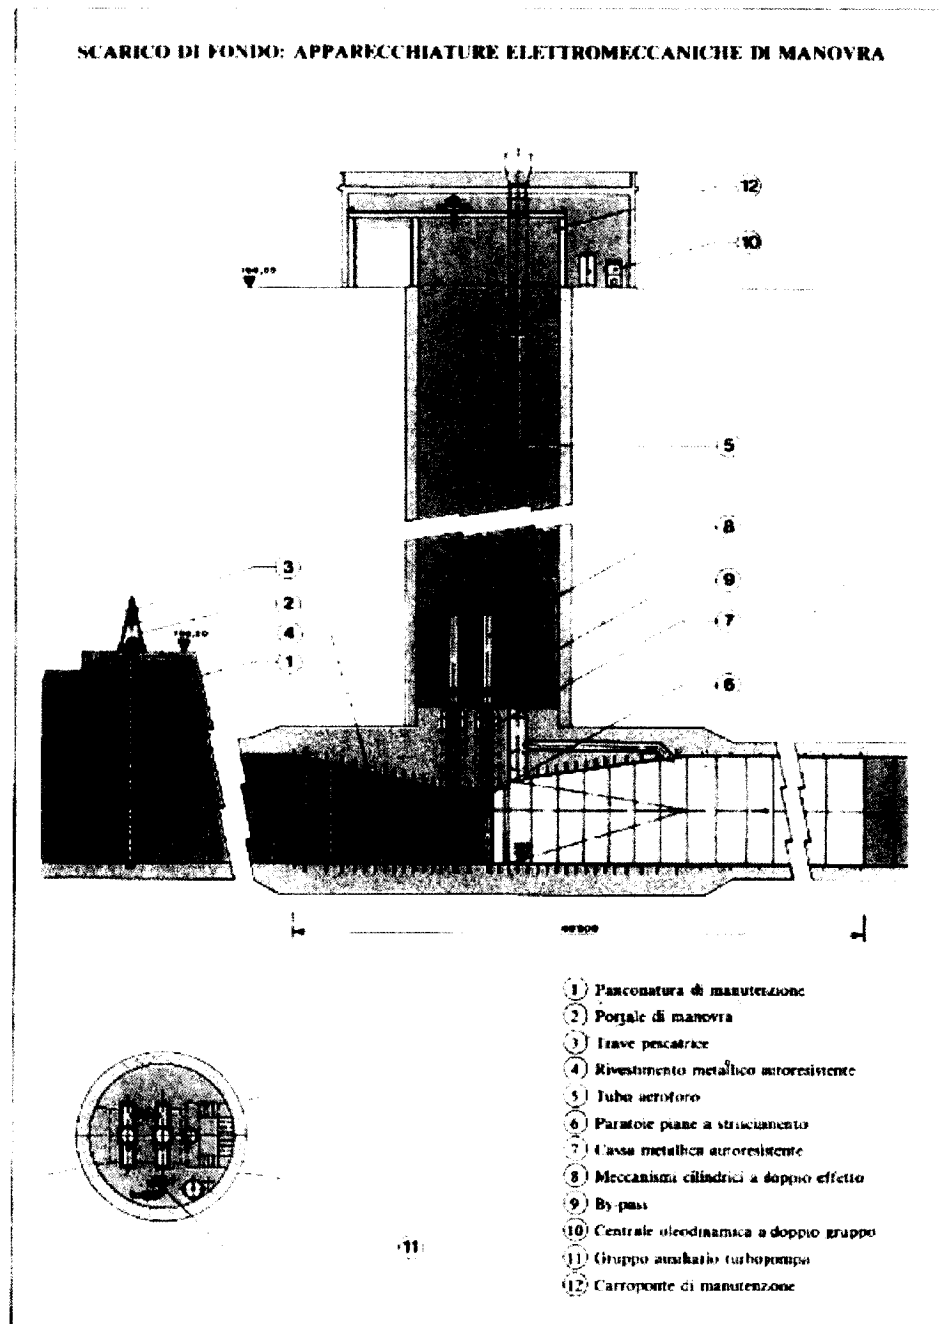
Sezione verticale del pozzo di accesso alla camera di manovra dello scarico di fondo
